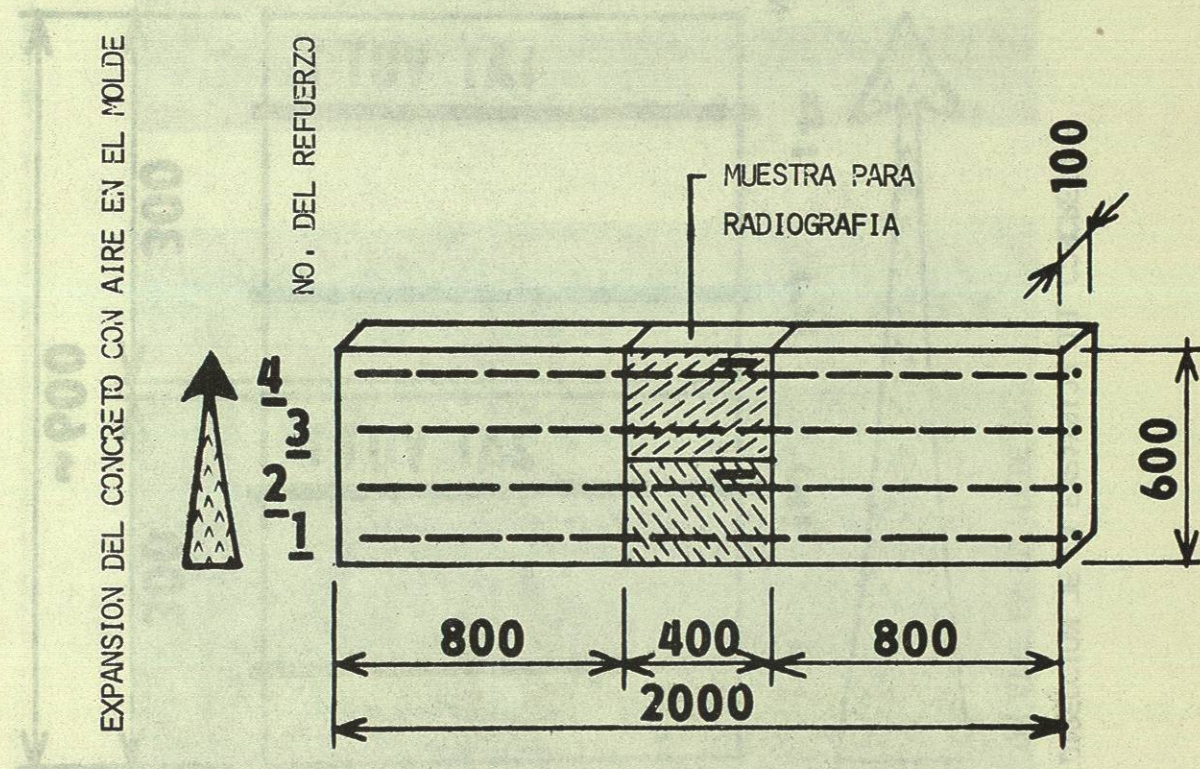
Muestras cortadas del panel de concreto con aire, reforzado e indicación del refuerzo (mm.).
